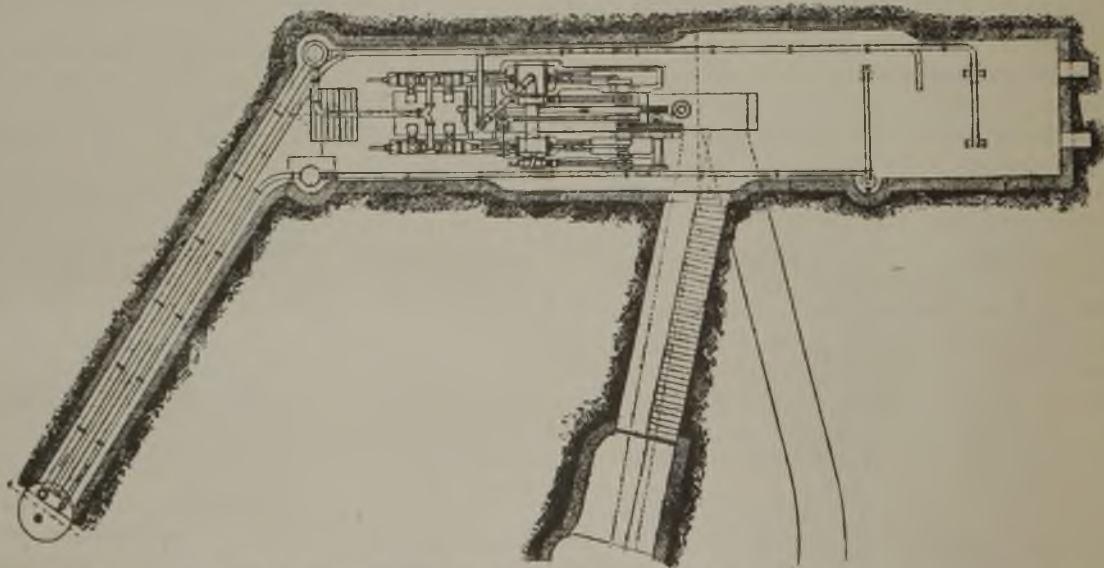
Grundriß der unterirdischen Wasserhaltung auf Zeche Arsimont.
